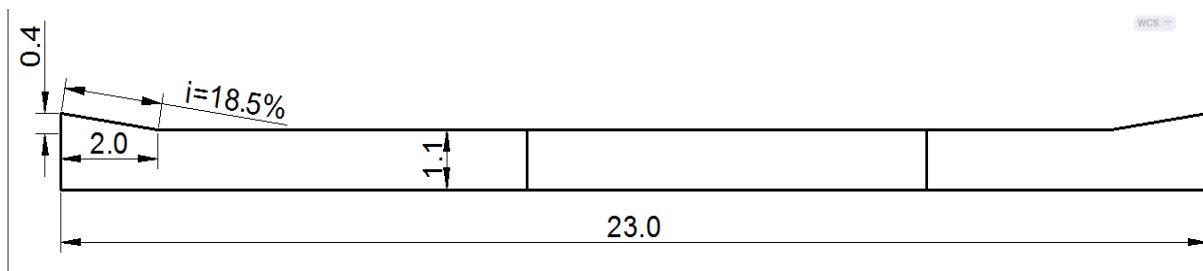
Pjesa e ulur e rampës në prerje ballore.
